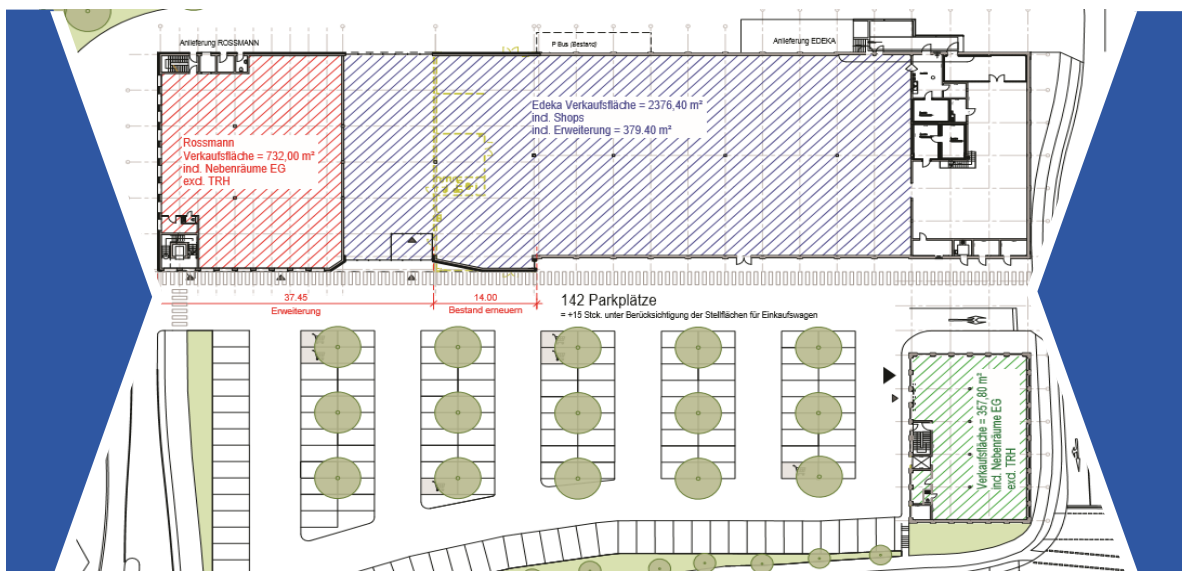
Ausschnitt des Lageplans - Verkaufsflächen, Quelle [6]
